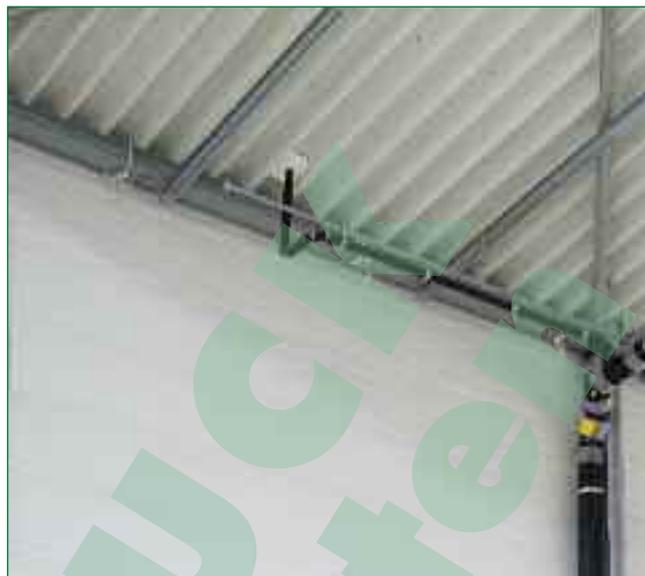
Mit flexiblen Anschlussrohren an den Pluvia Dach-einläufen ist eine schnelle und zeitsparende Anbindung an die Pluvia Regenwasserleitung gewährleistet
